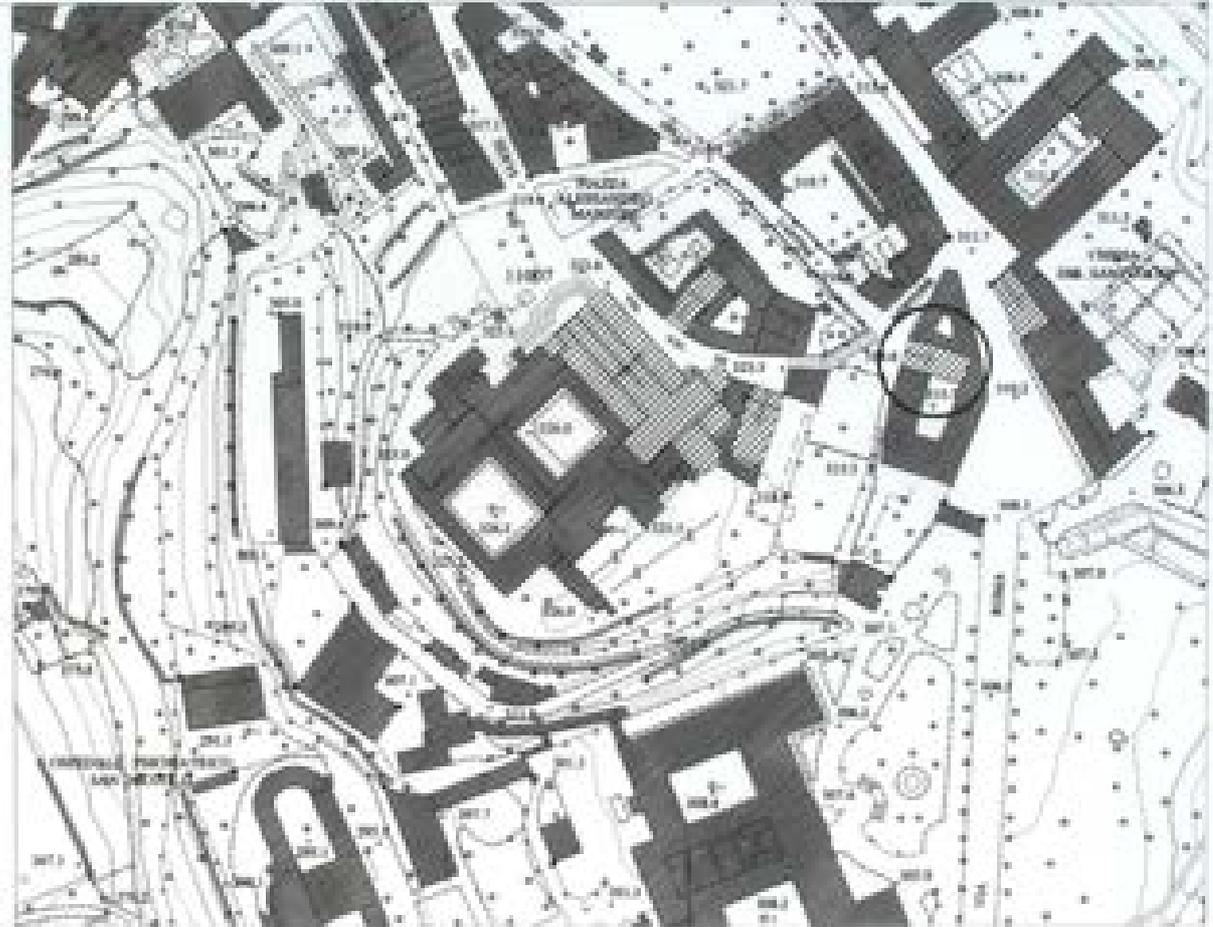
Pianta – stato attuale – Bruno Sacchi – 10/06/2003 (AABS-94.209)
